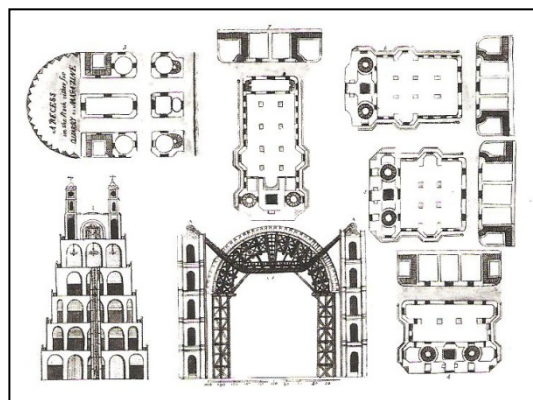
, William Bridges, Uma ponte sobre o rio Avon: Plantas e Cortes, 1793. Gravura.
